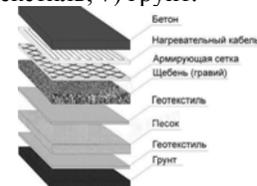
Установка нагревательного кабеля при бетонном покрытии
